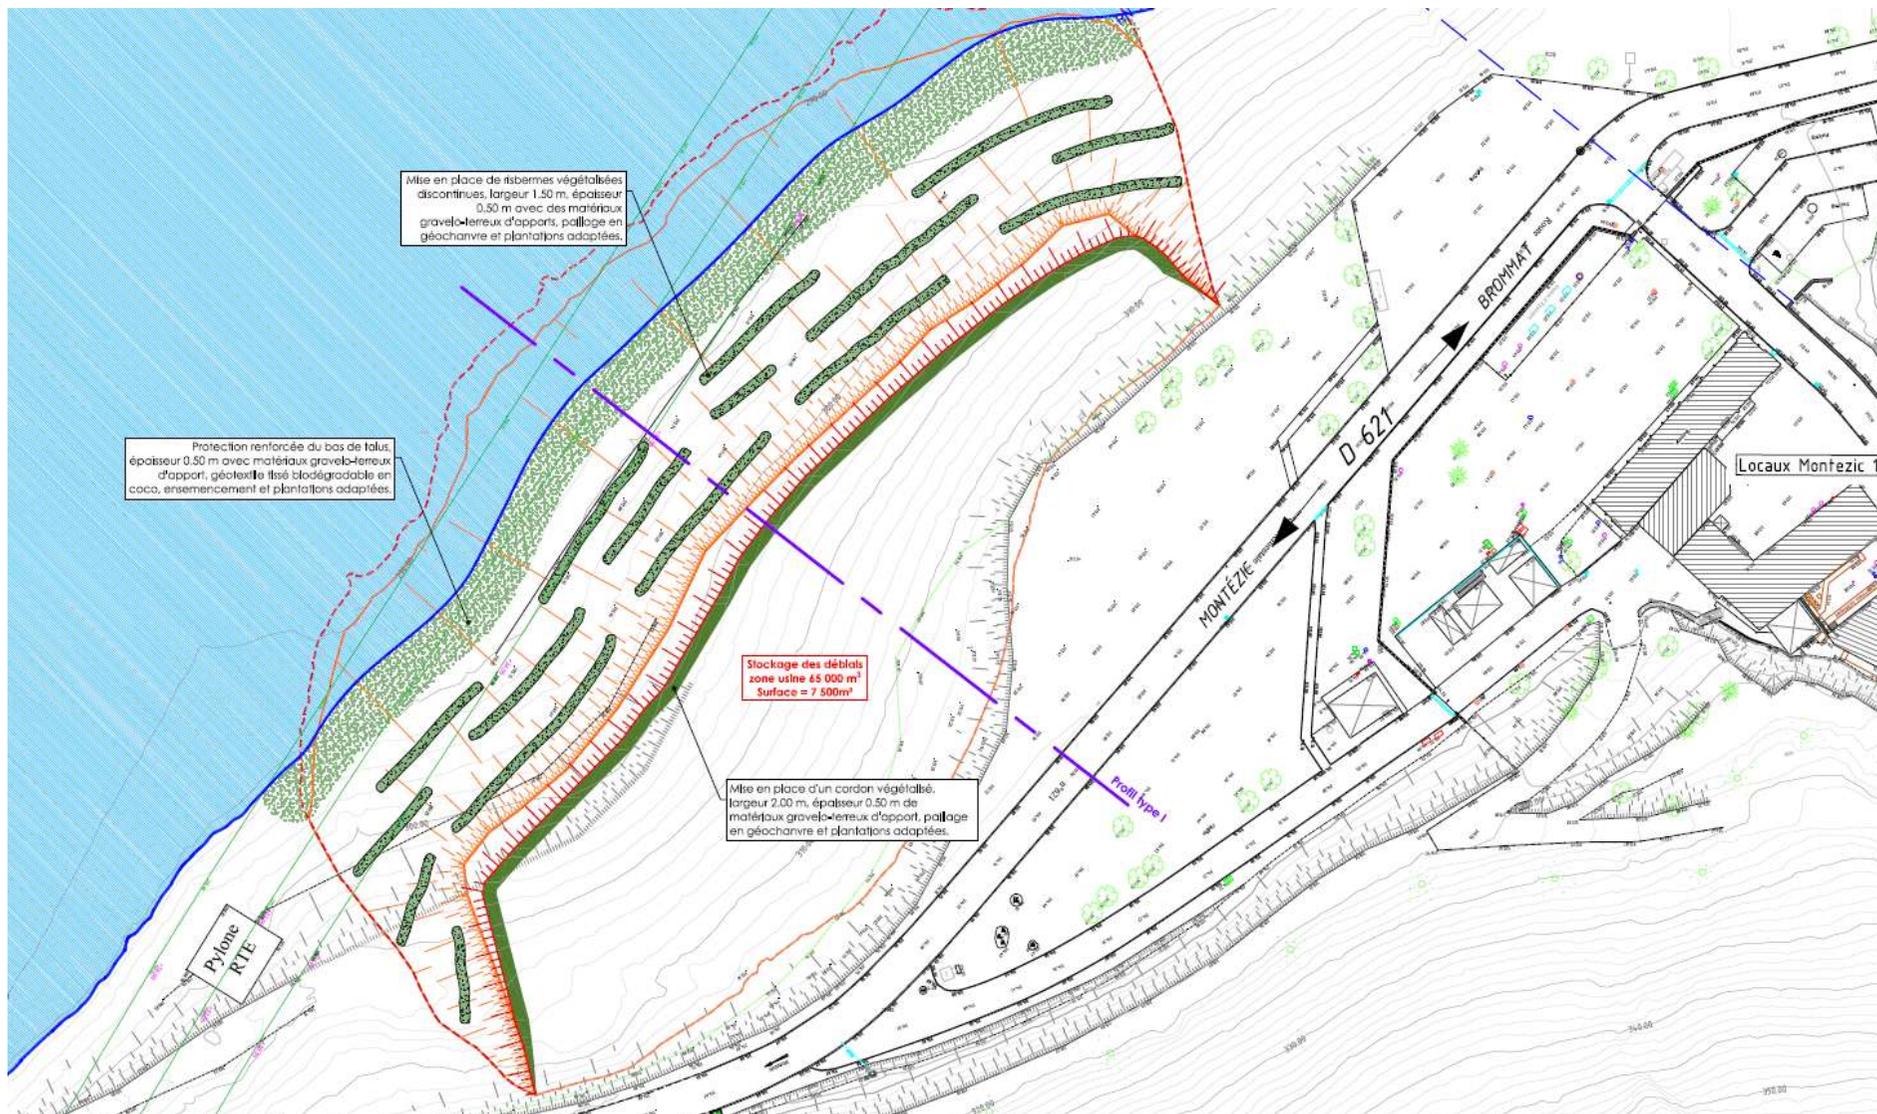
Plan de restauration du talus de la plateforme devant le GU – source : BIOTEC
